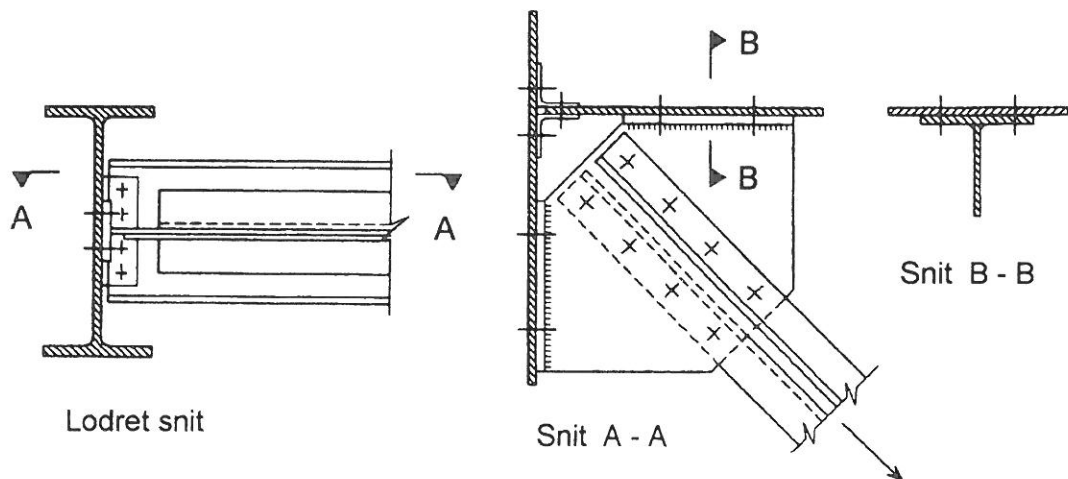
Fordeling af kræfter mellem bøjning (vandret plade) og træk (lodret plade).
